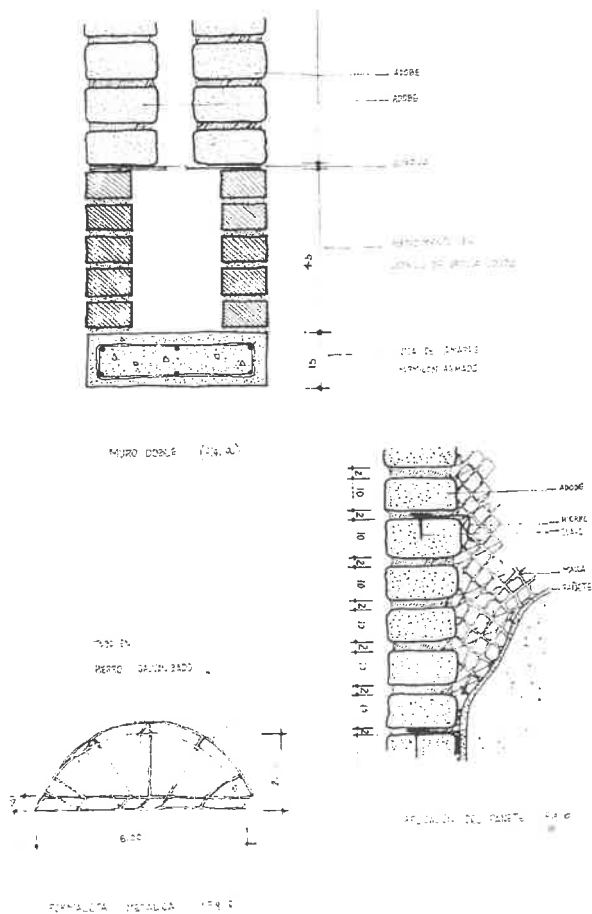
DETALLES CONSTRUCTIVOS DE LOS MUROS Y FORMALETA PARA CONSTRUIR LA BOVEDA.
